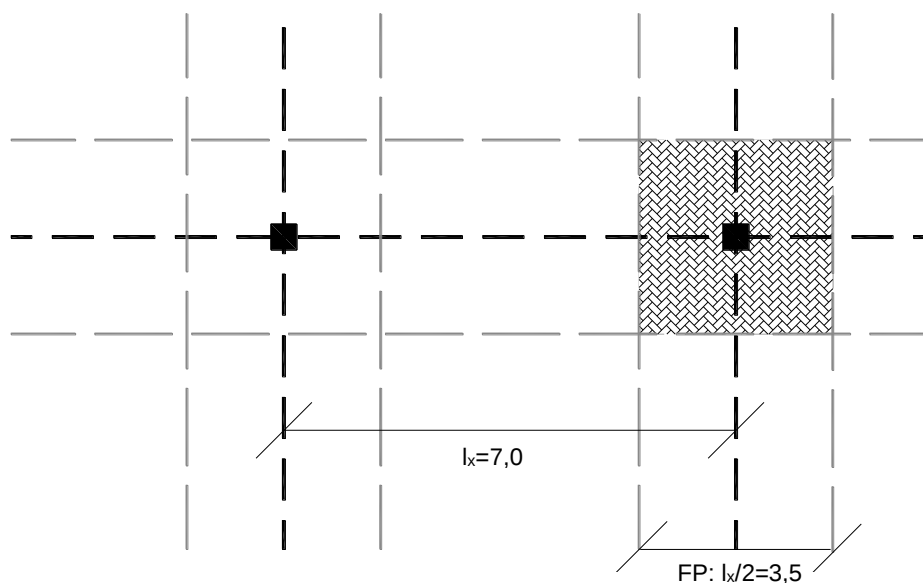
Representação em planta da faixa sobre os pilares no modelo 2D
